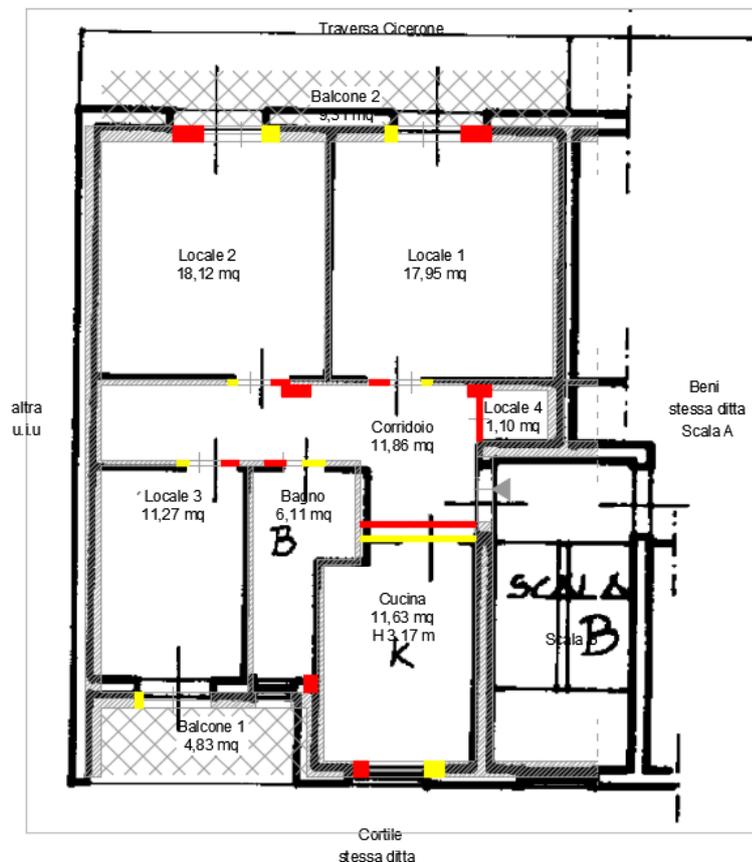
Confronto con planimetria catastale (Foglio 4, p.la 1225, sub. 9)
